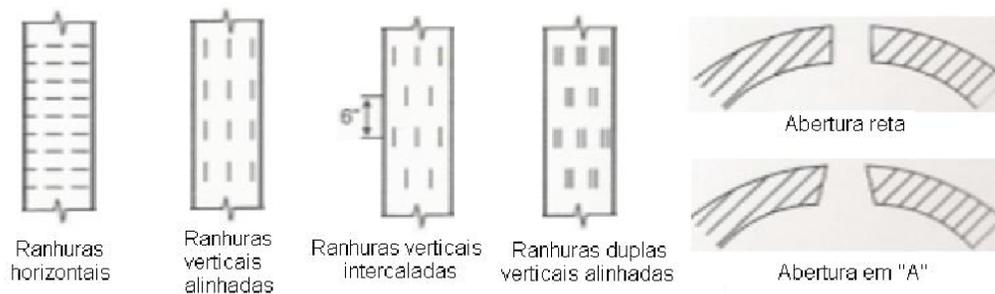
Disposição das ranhuras no tubo (Borges, 2007).
